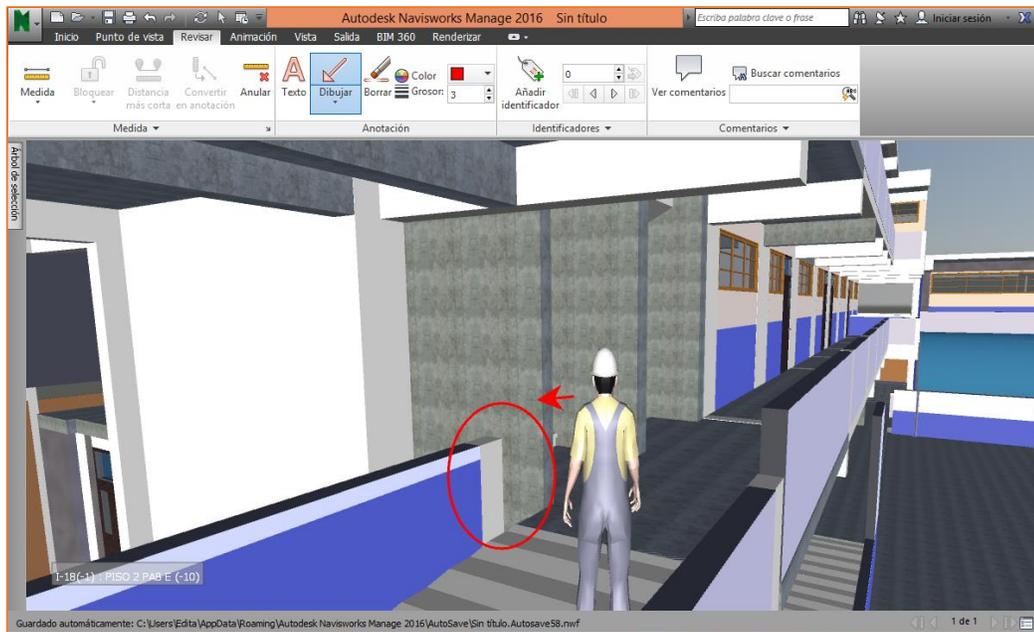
Construcción de las columnas en el Nivel 2 del pabellón C2 (verde) (Navisworks Manage 2016).
